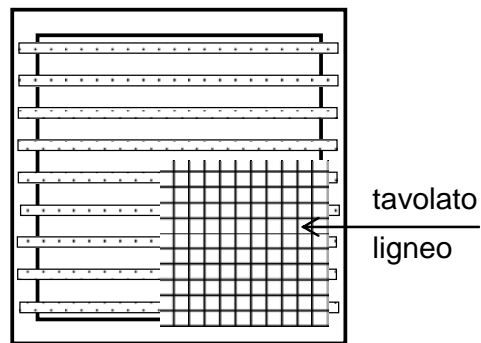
a*. Solaio con travetti e tavolato ligneo (lo schema raffigura un riquadro del tavolato).
